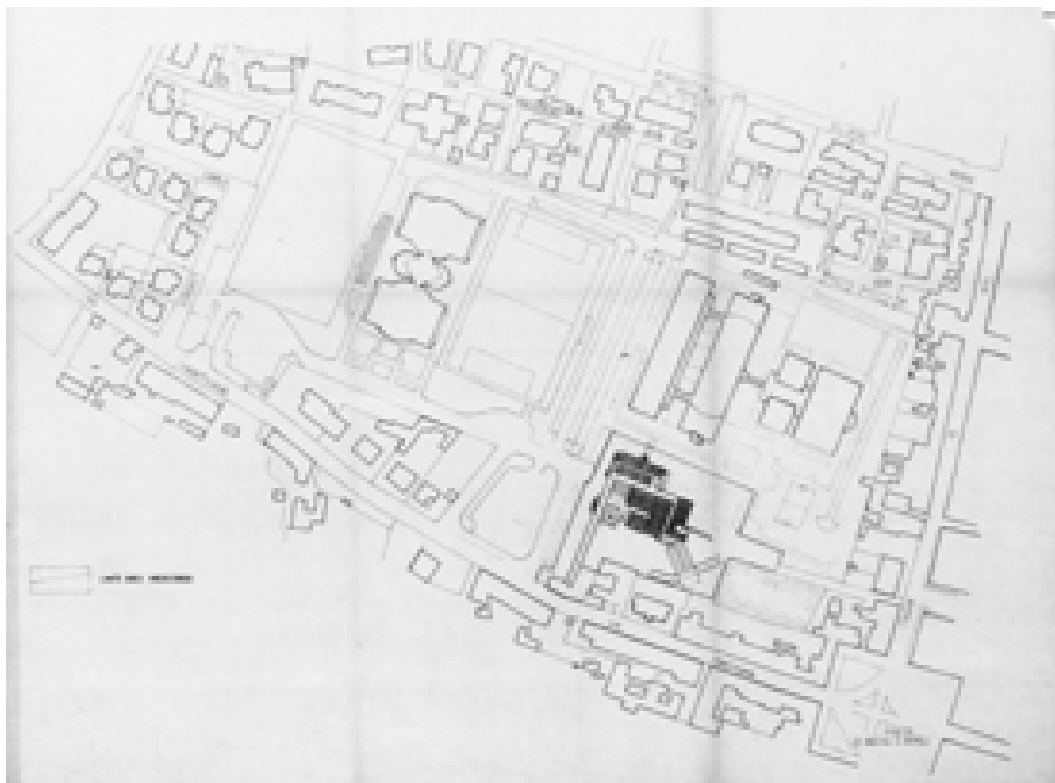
Planimetria, stato futuro - 1989 (AABS-64_703)
